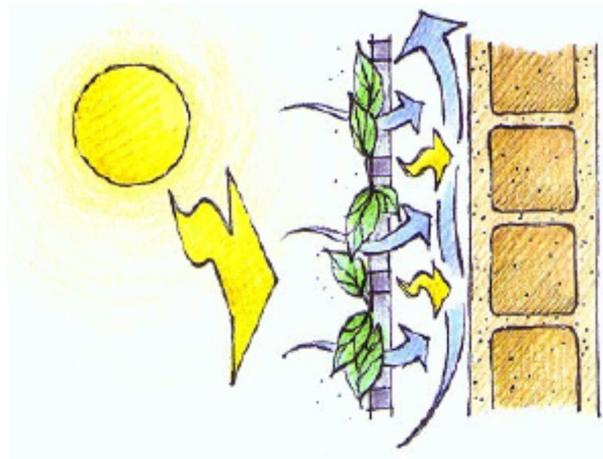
Detalhe esquemático da ventilação – Fachada verde Ecohouse Urca, Rio de Janeiro
